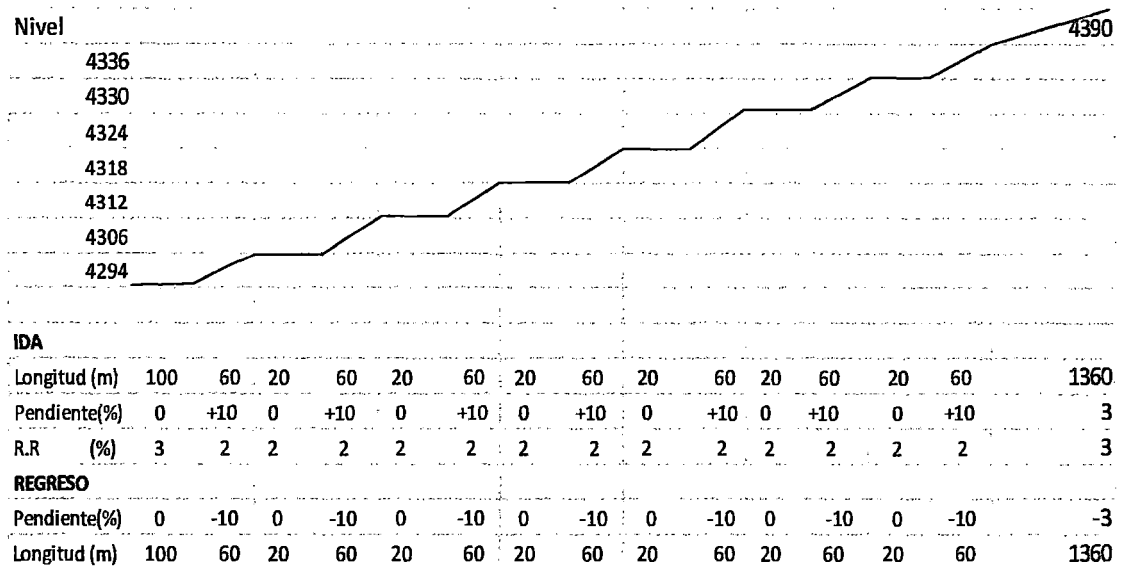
Alzado del perfil de transporte de la ruta N° 04
